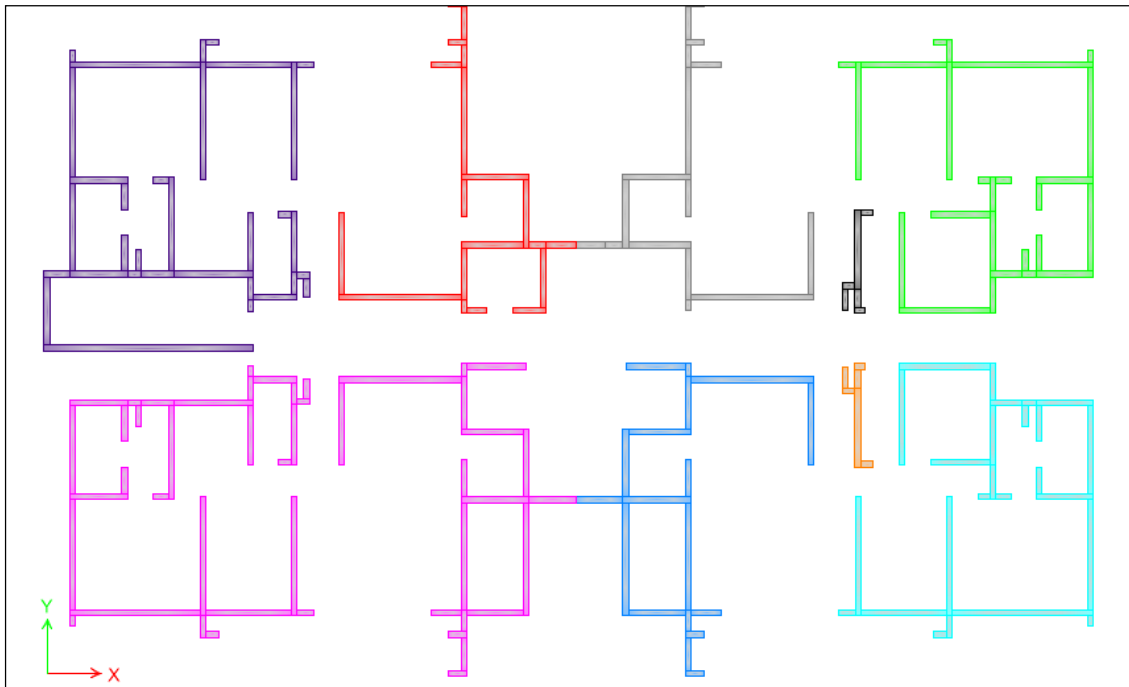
Vista en planta del Edificio J (elementos tipo barra de sección transversal irregular)
